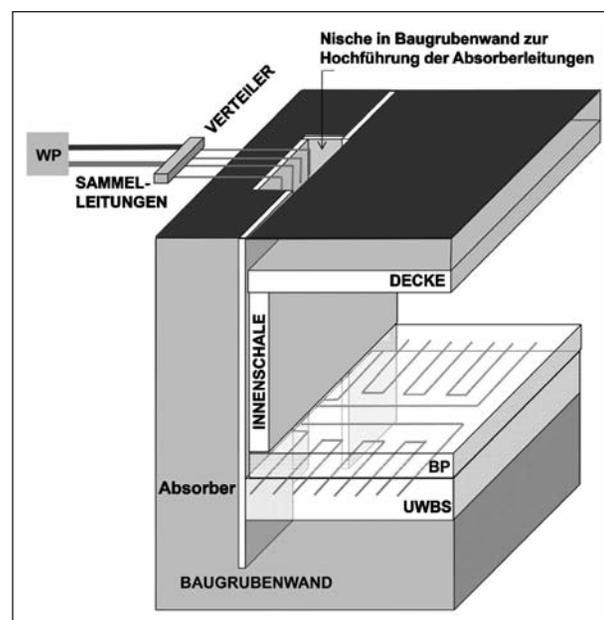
Beispielhafte Situierung von Absorberleitungen in einem Tunnel mit offener Bauweise (z. B. mit Spundwand und Unterwasserbetonsohle als Baugrubenumschließung)
